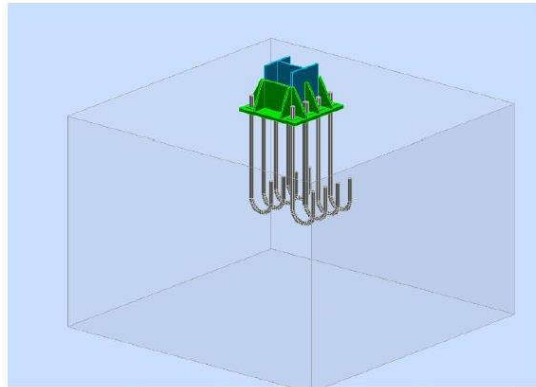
3D d'assemblage pied de poteaux.
